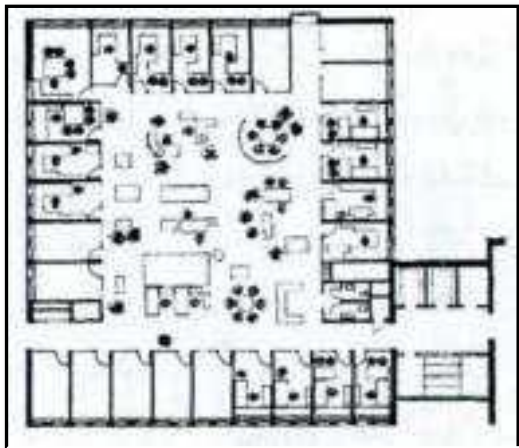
مسقط أفقي بنك هونغ كونج بشنغهاي
